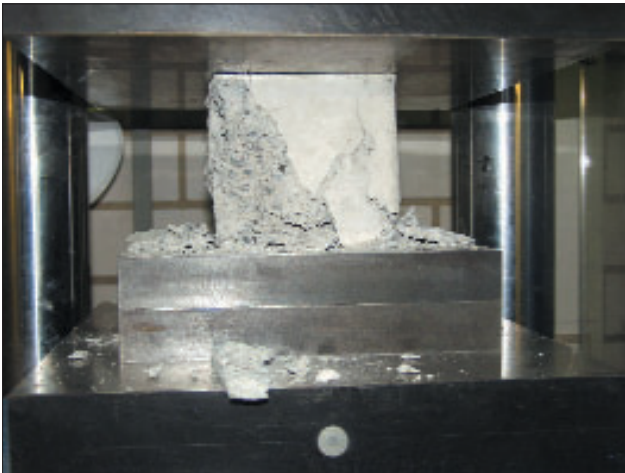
Druckfestigkeitsprüfung am Betonwürfel
